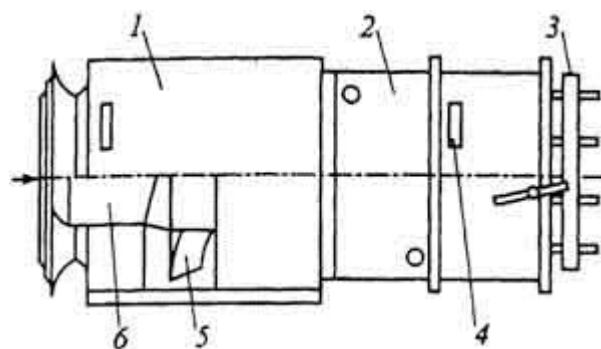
Подвесной воздушно-рециркуляционный отопительный агрегат: 1 - корпус; 2 - воздухонагреватель; 3 - воздушный клапан; 4 - кронштейн; 5 - осевой вентилятор; 6 - электродвигатель
